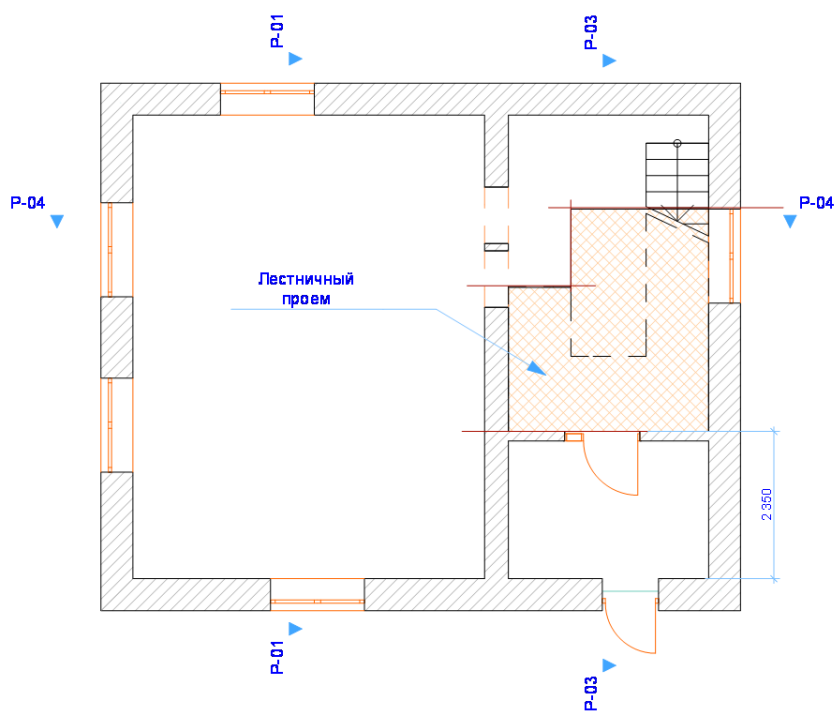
План первого этажа с размерами проема для вырезания отверстия в перекрытии второго этажа.
